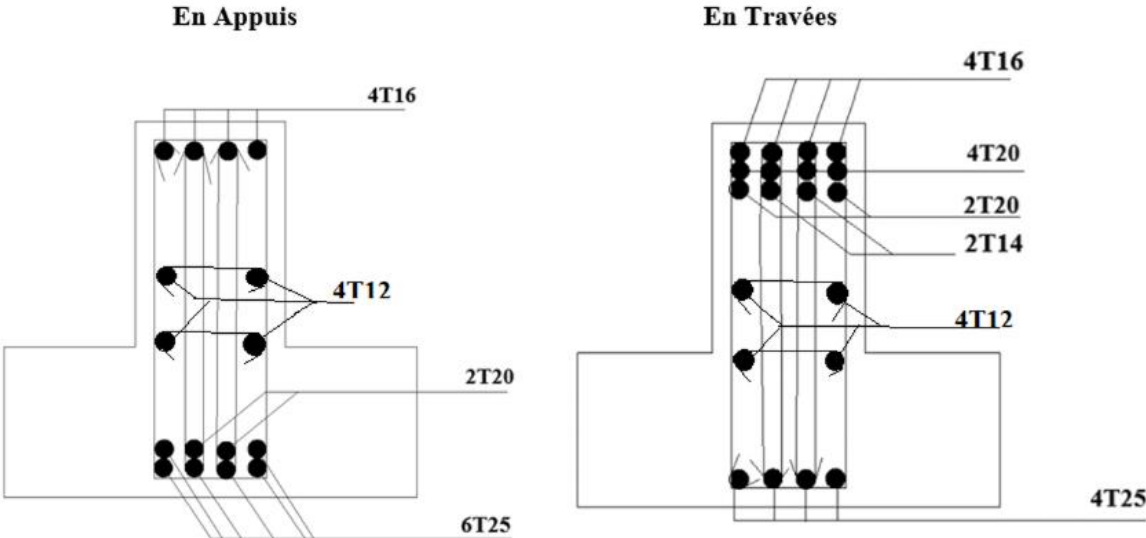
Dessin de Ferrailage de la poutre principale.
